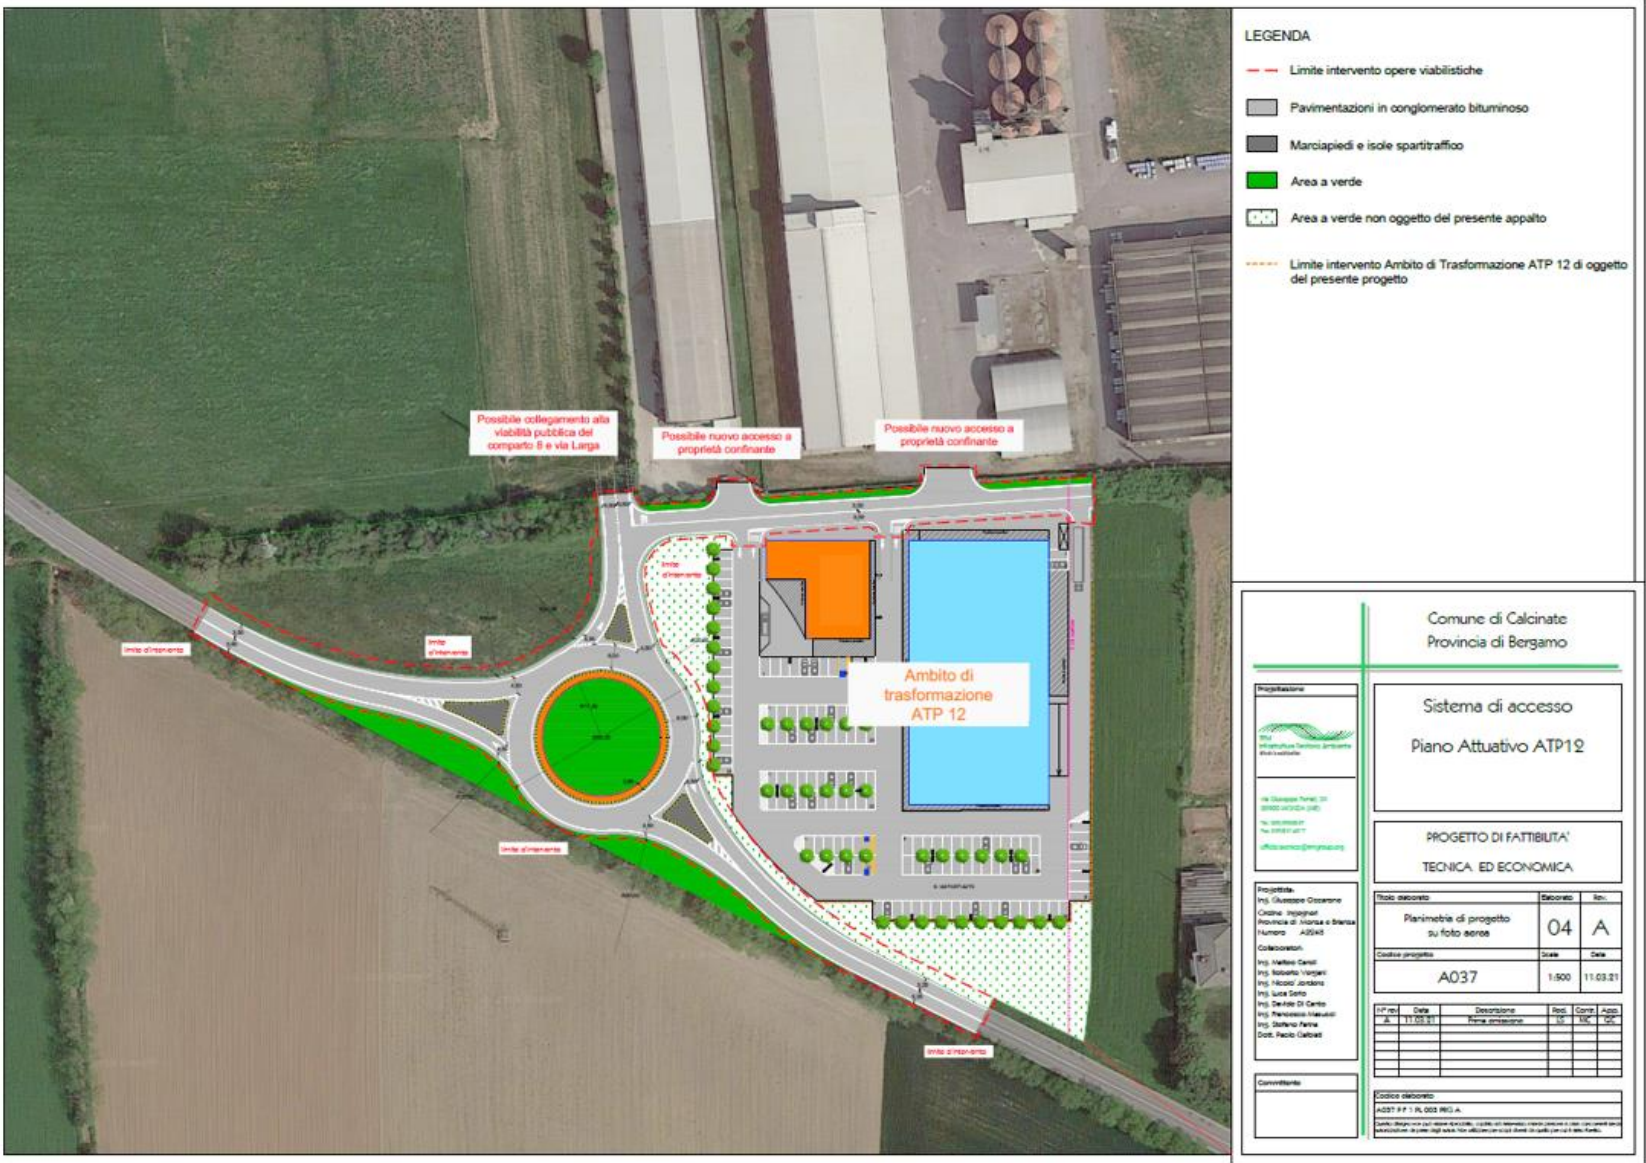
PFTE opere stradali – Planimetria di progetto su foto aerea con la nuova viabilità ATP 12
